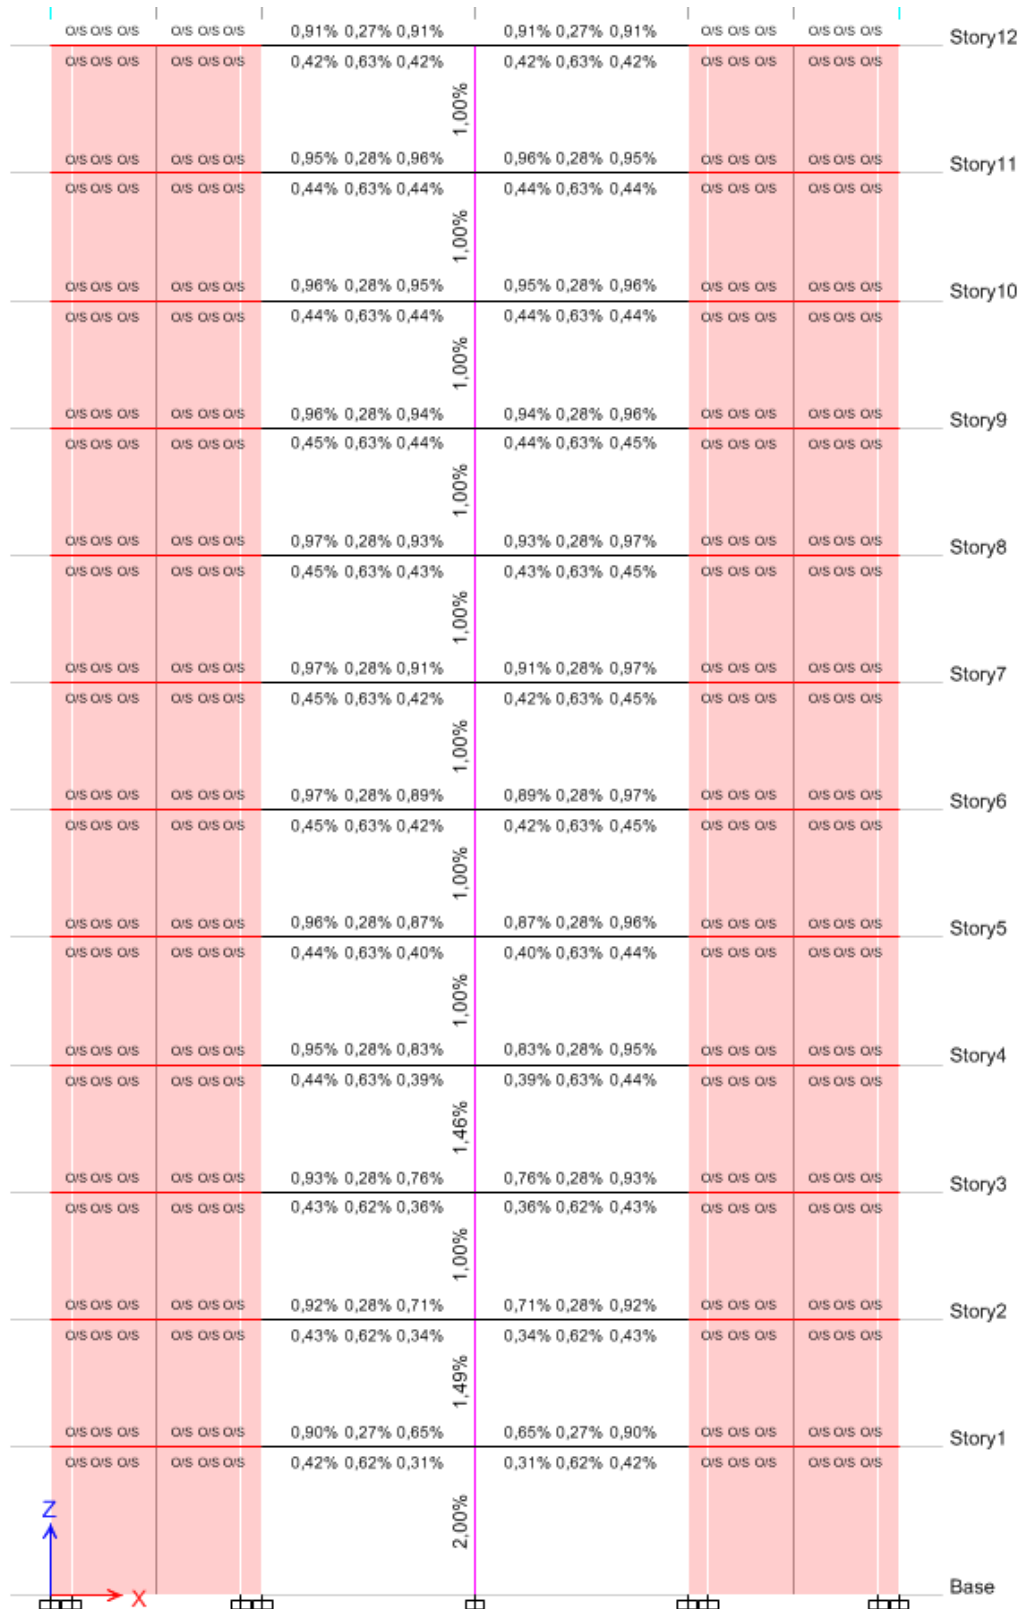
Cuantía de refuerzo para pórtico de edificio con muros 12 pisos, DBF.
